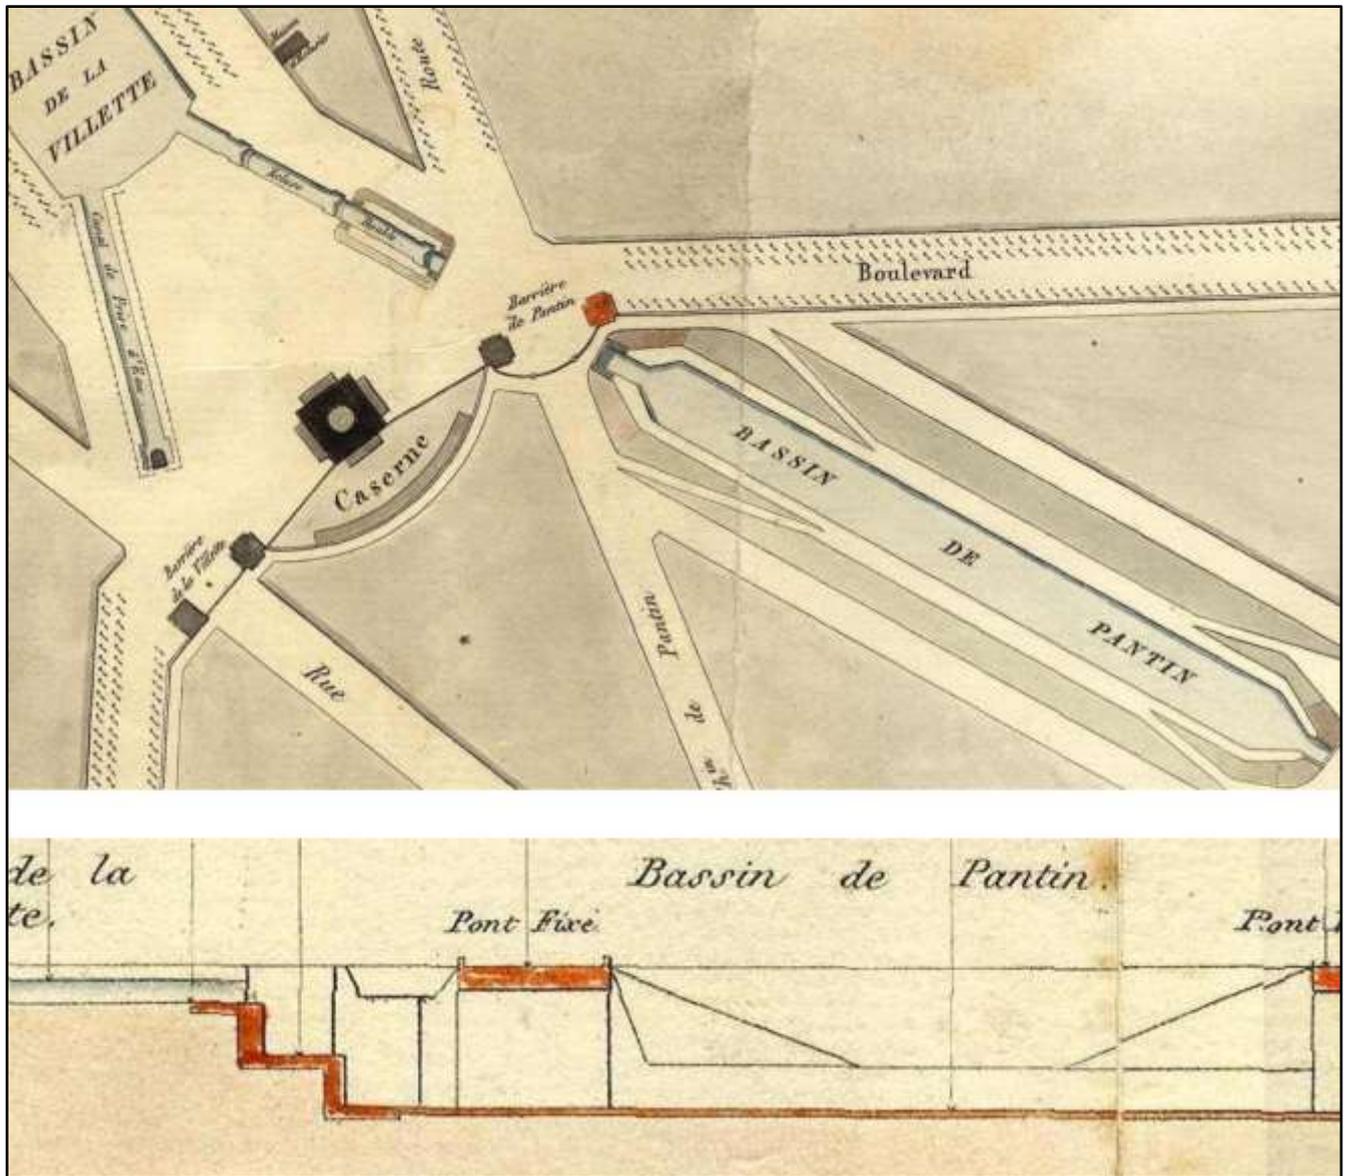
Plan et coupe longitudinale de la jonction du bassin de la Villette et du canal Saint-Martin.
